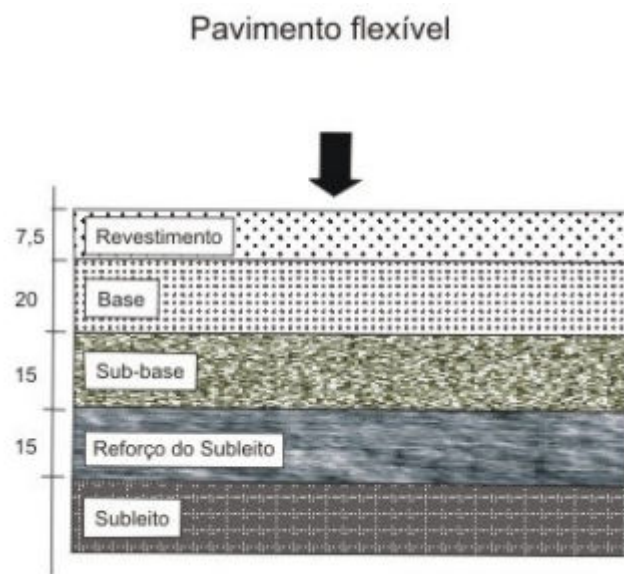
Perfil da Seção Típica de Pavimento Flexível.
